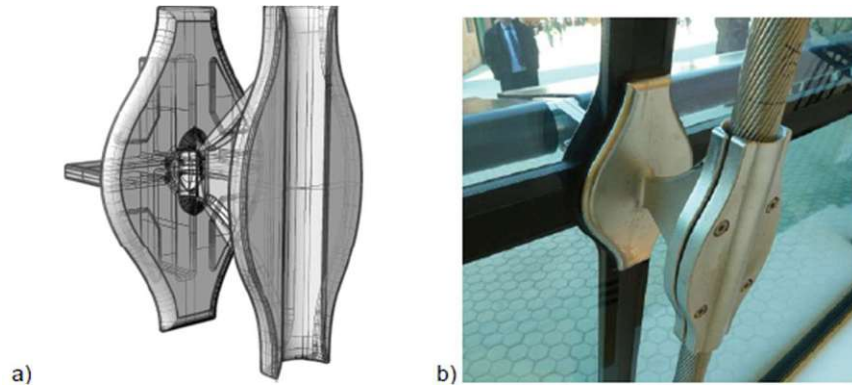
Fassadenhalterung – a) 3D-Modell, b) Montage auf der Fassade [43]
